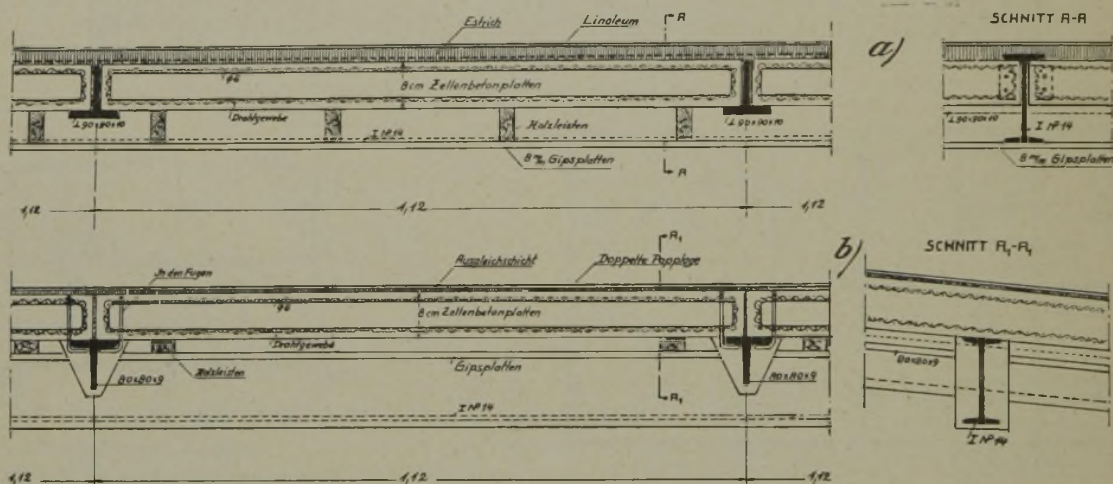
Deckenkonstruktion. Abb. 6b. Dachkonstruktion des Hamburger Hauses.
